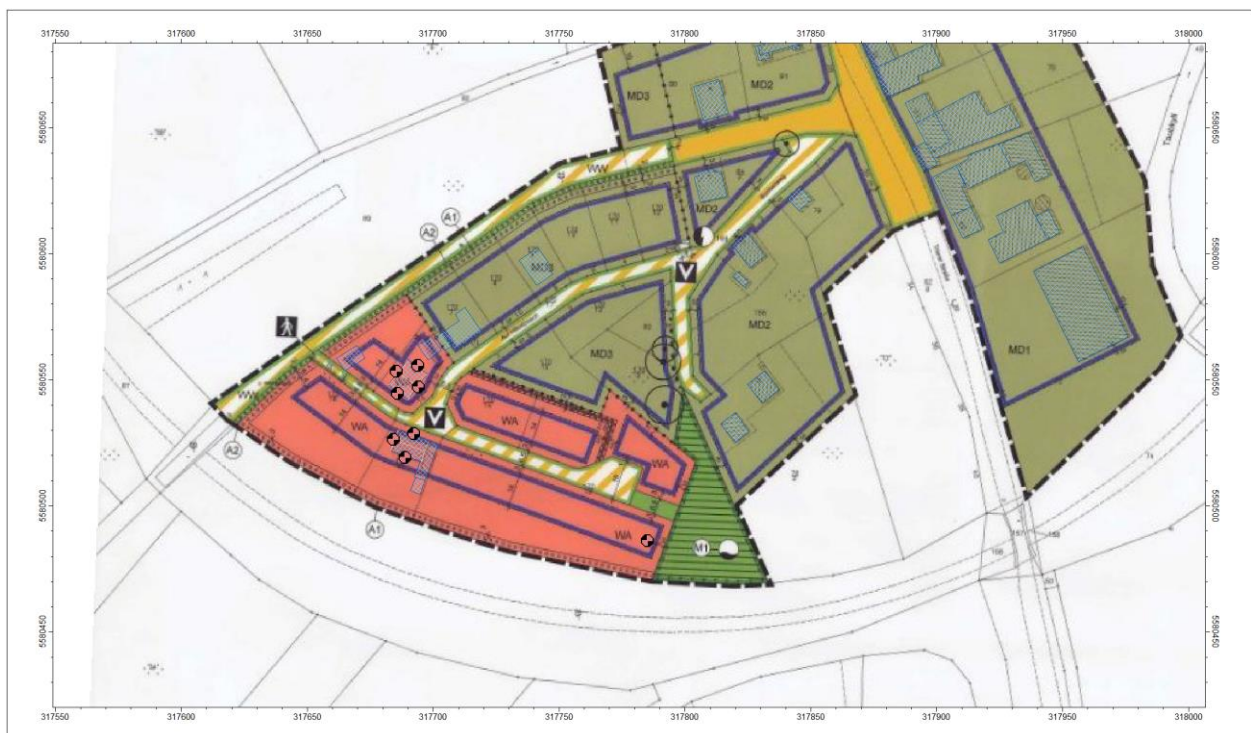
Ausschnitt Bebauungsplan „Häselpesch“
